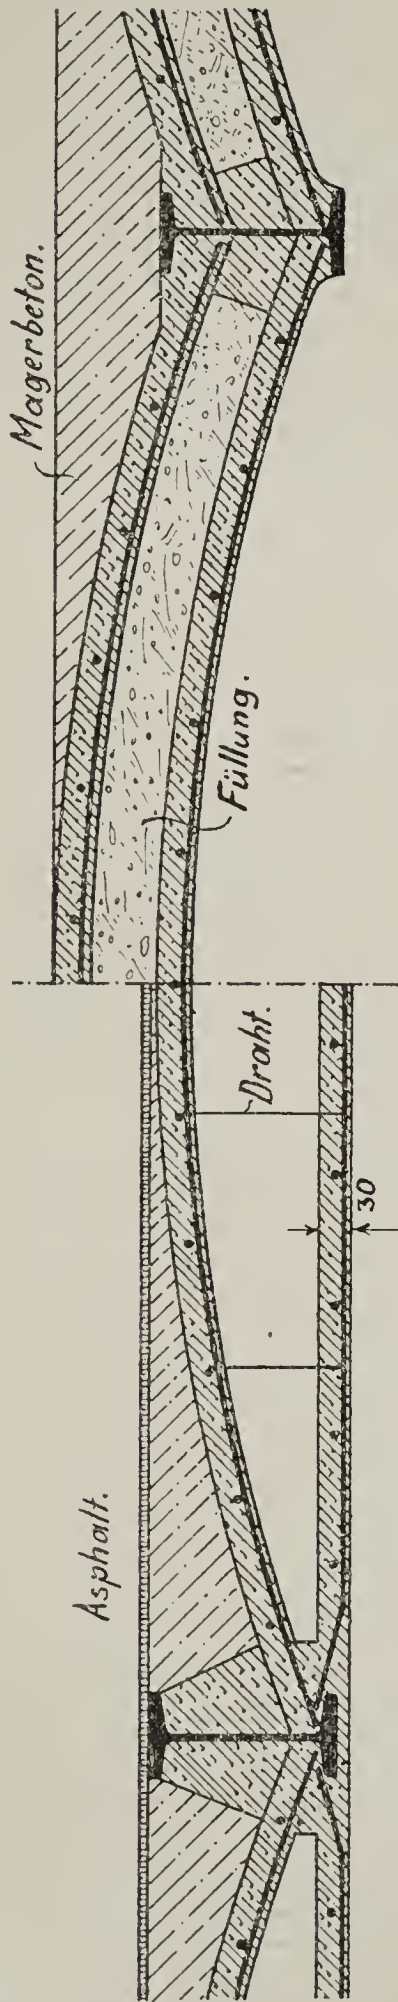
und 66. Decken mit doppelter Monierkonstruktion.
